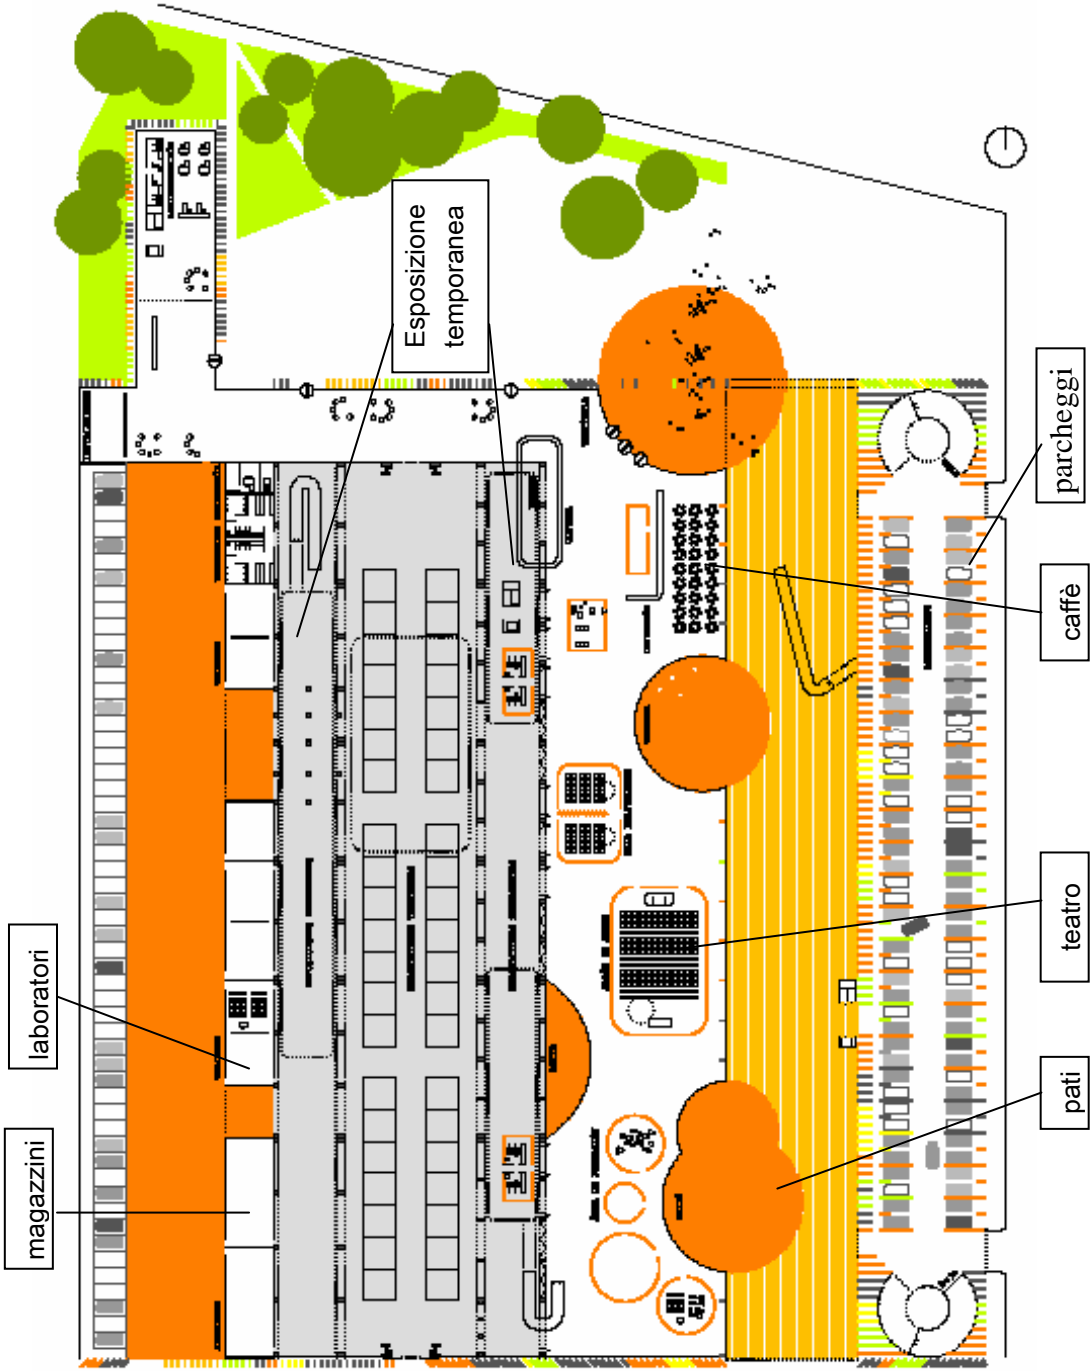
pianta piano terra, progetto per la Nave Torroja, "Banda Ancha" Joaquín Lizasoain, Josemaría Churtichaga, Rofi Brulisaue Y Mauro Doncel, Ophelia Manz.
